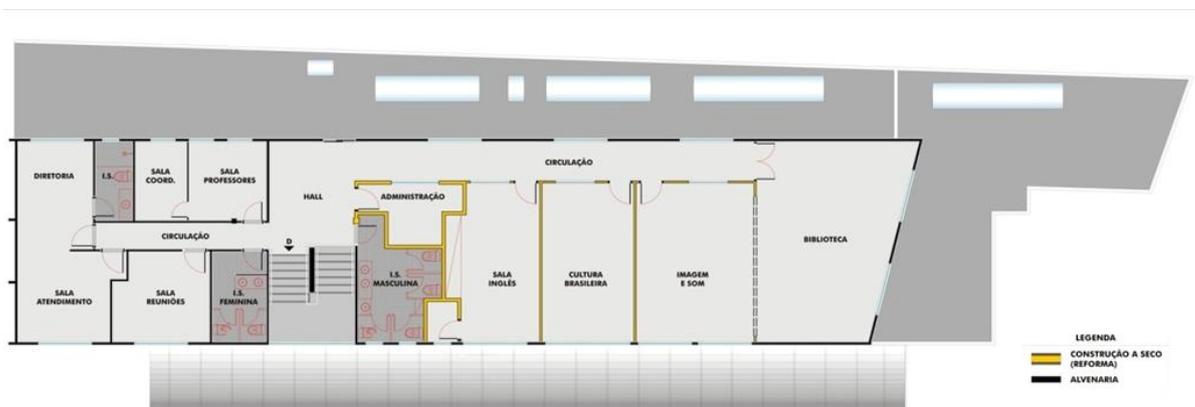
Planta 2º Pavimento - Escola *Builders*.
